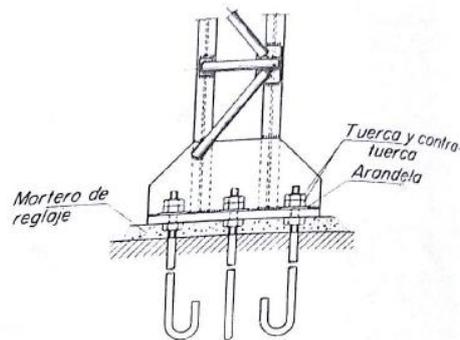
Unión mediante pernos de anclaje. (Fuente: (Miravete & Larrodé, *Los transportes en la ingeniería industrial (teoría)*, 2002))
